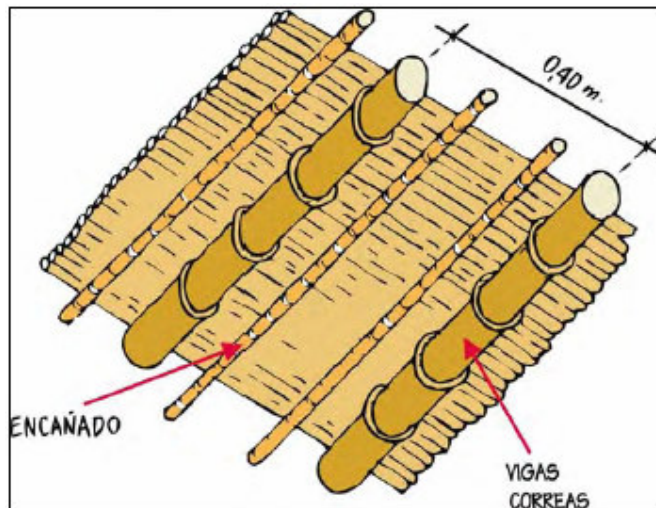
Entechado. Fuente: (Gómez, 2004).
